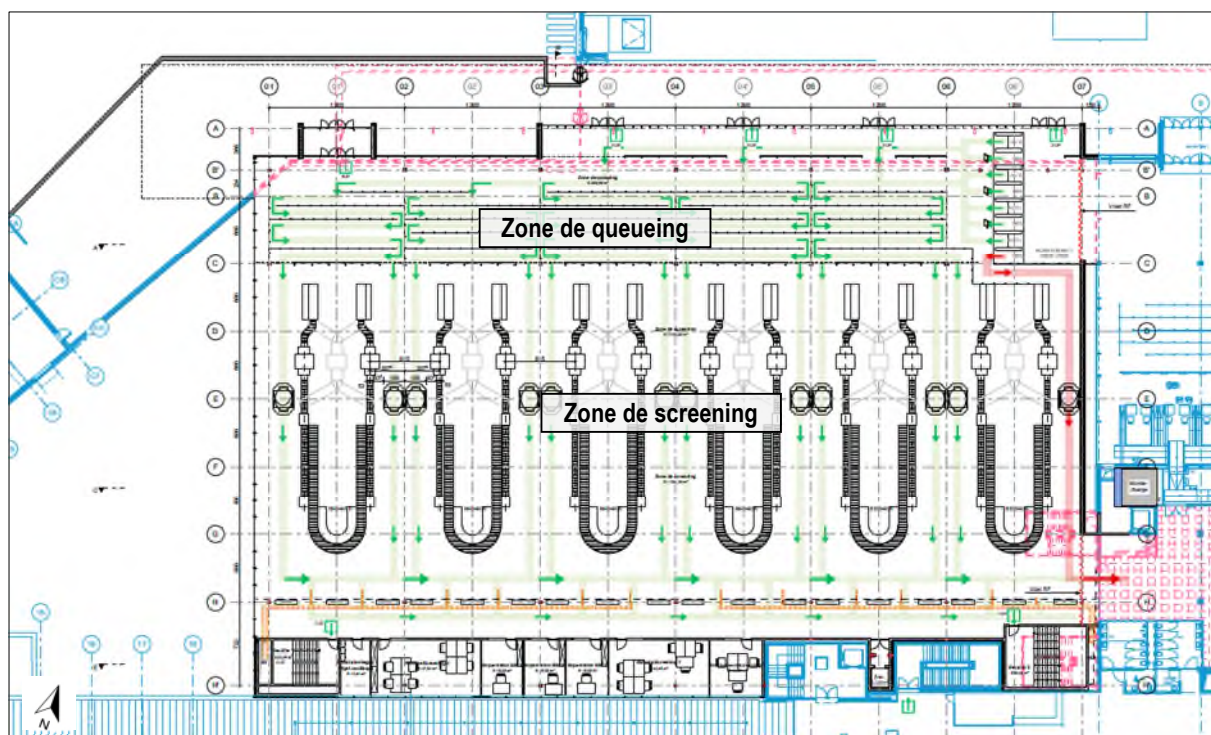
Extension du PIF Nord – Plan R+1 – Niveau +177,00 m (BAG-AERTEC, 2024)
